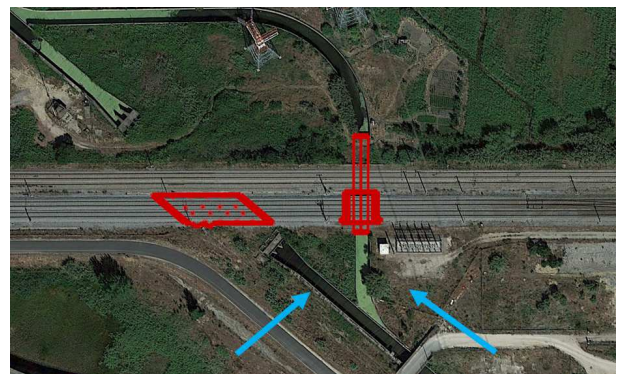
Pk 37+443 - By-pass ao canal de adução (Telas Finais de 2004 des. LN1293631)
